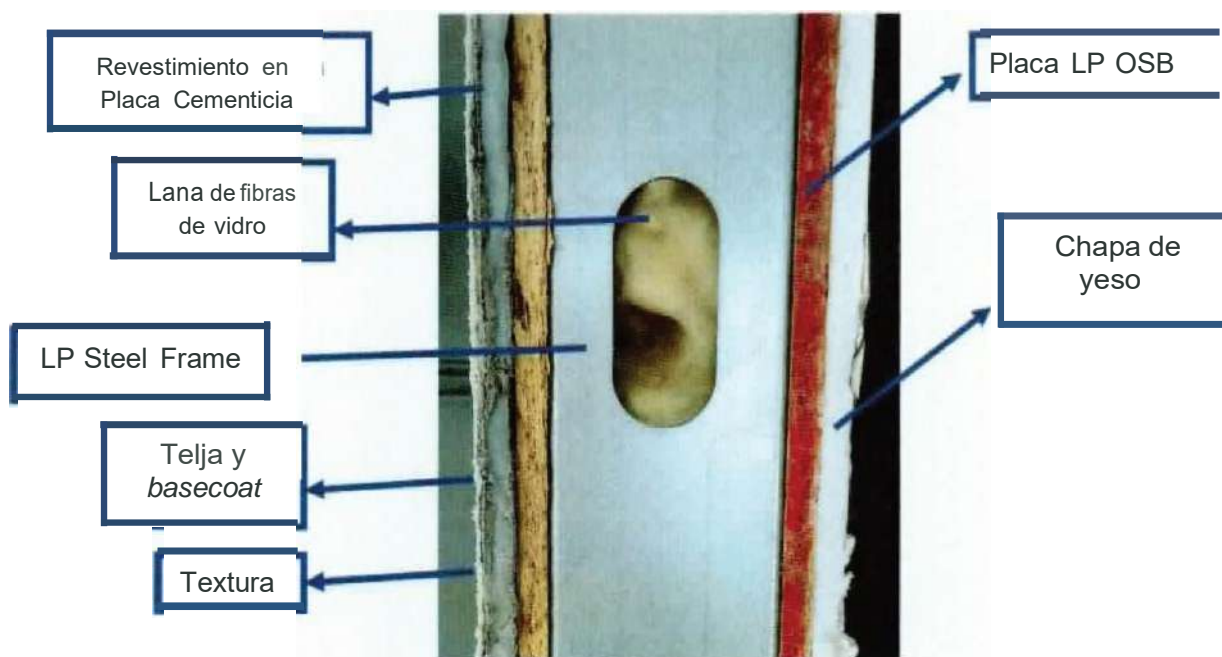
Detalle de las capas del sistema de fachada ensayado.
